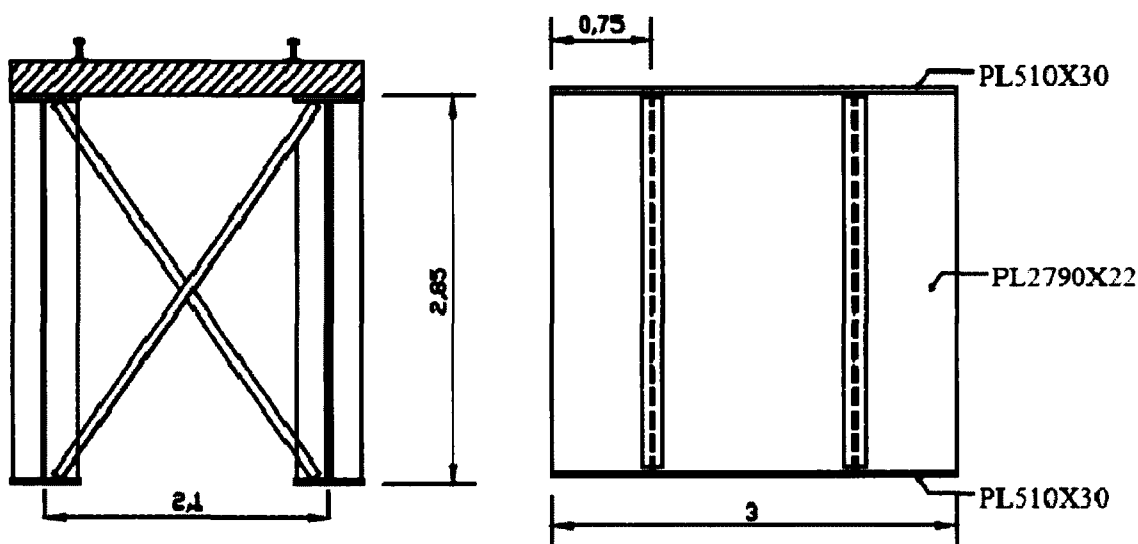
Pont bi-poutres - Section transversale et élévation - Section D-3
